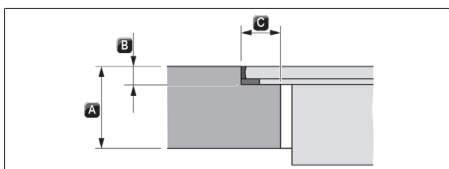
Dimensiones de rebajo para instalación enrasada
